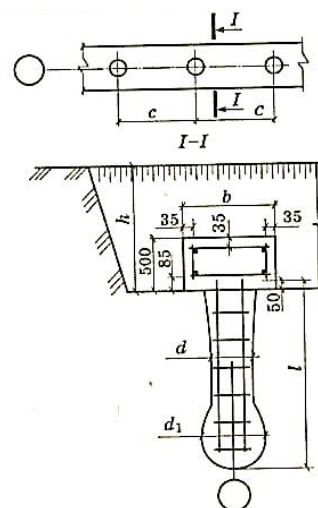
Общий вид фундаментов из буронабивных свай с монолитным ростверком, к табл. 7
